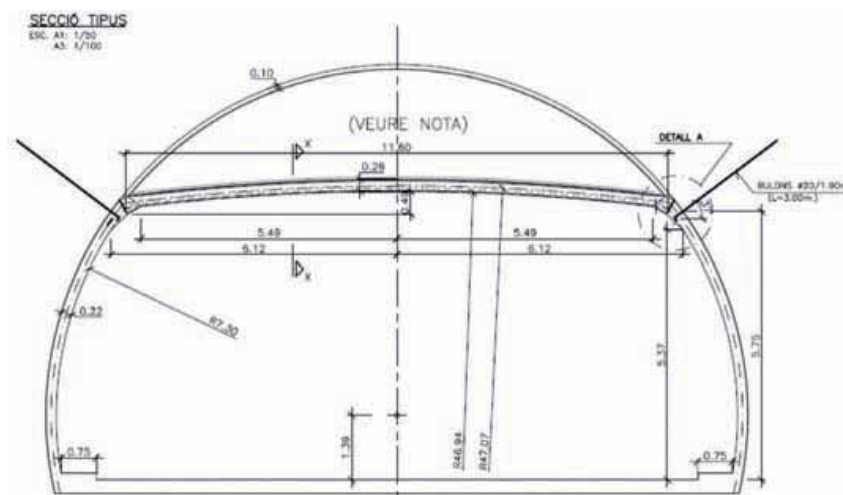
Sección tipo del forjado mixto ligero en falso techo.
